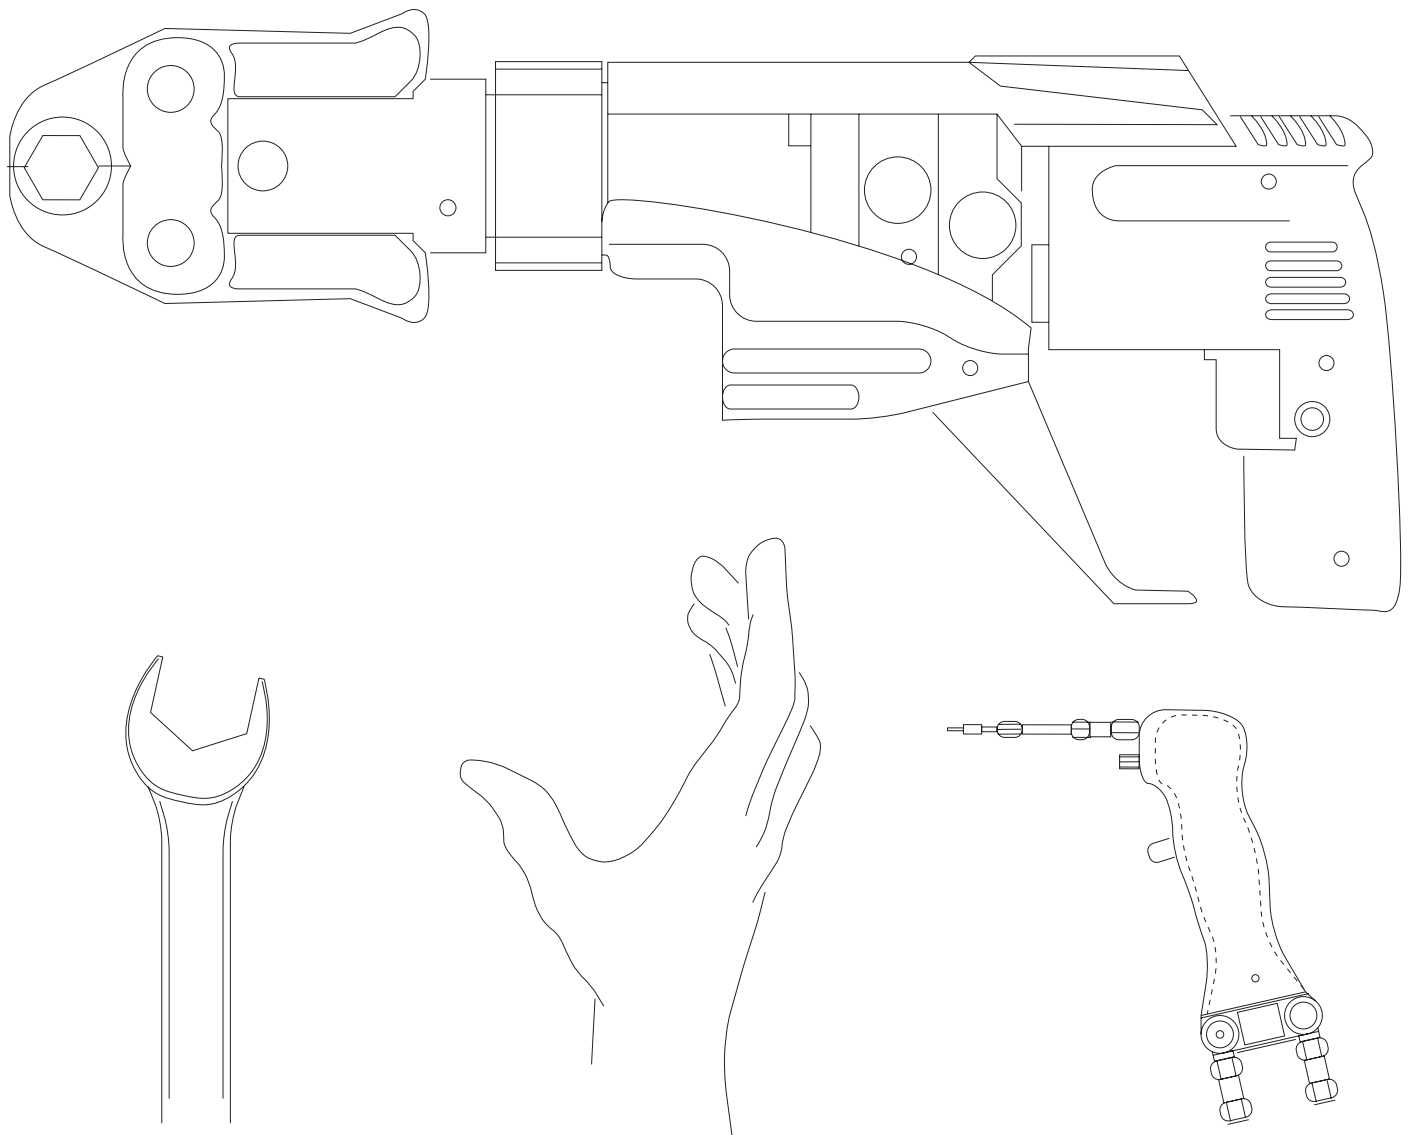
Werkzeuge zur Bearbeitung, Montage und Demontage von Rohrleitungen
